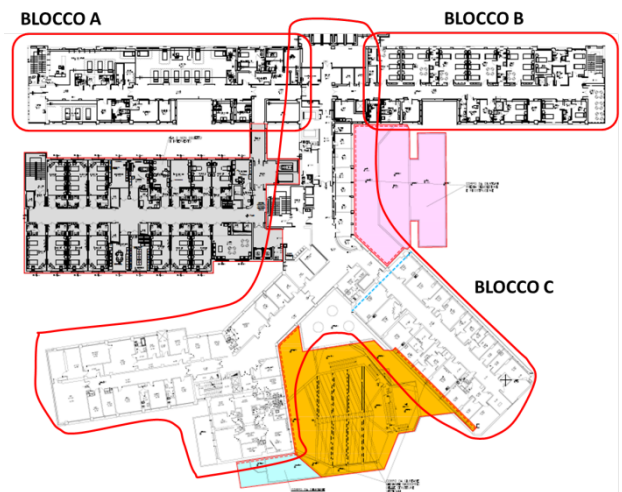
Padiglione 5 pianta piano primo – zona grigia (Ala G, non oggetto del presente progetto), zona rosa (Atrio,
